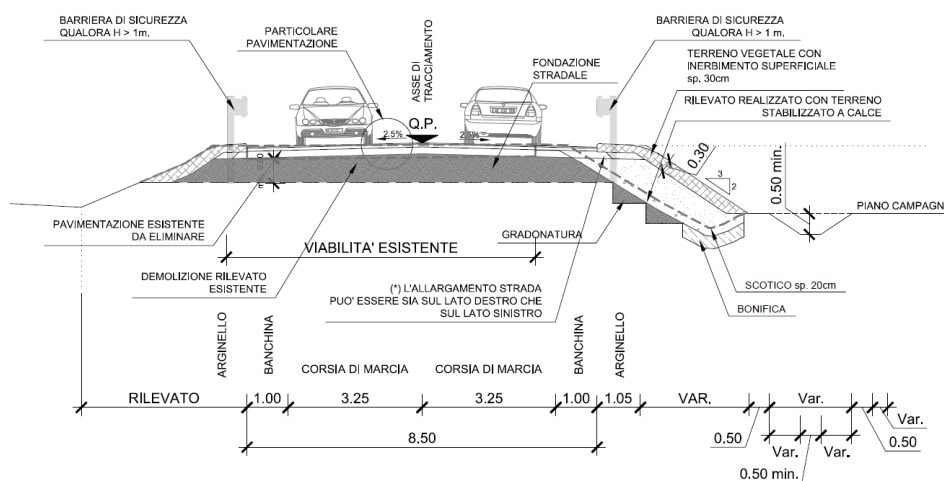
ESEMPIO DI SEZIONE TIPO F LOCALE IN RETTIFILLO
